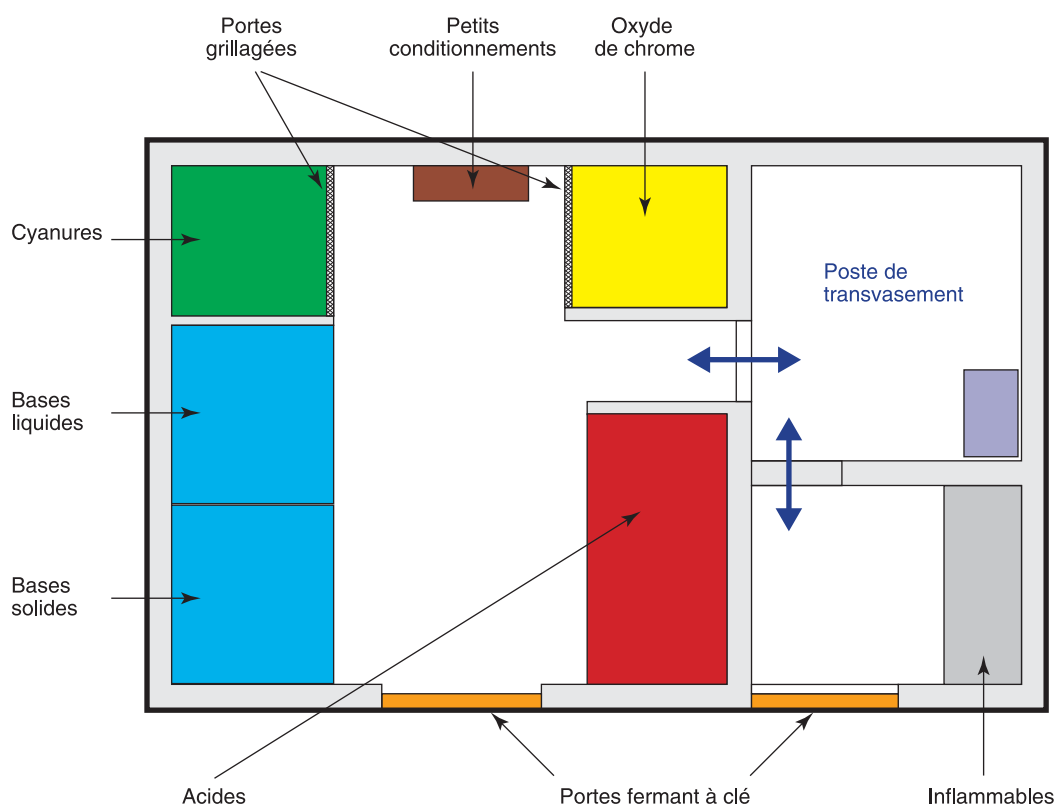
Plan type du stockage des produits en conditionnements unitaires.
